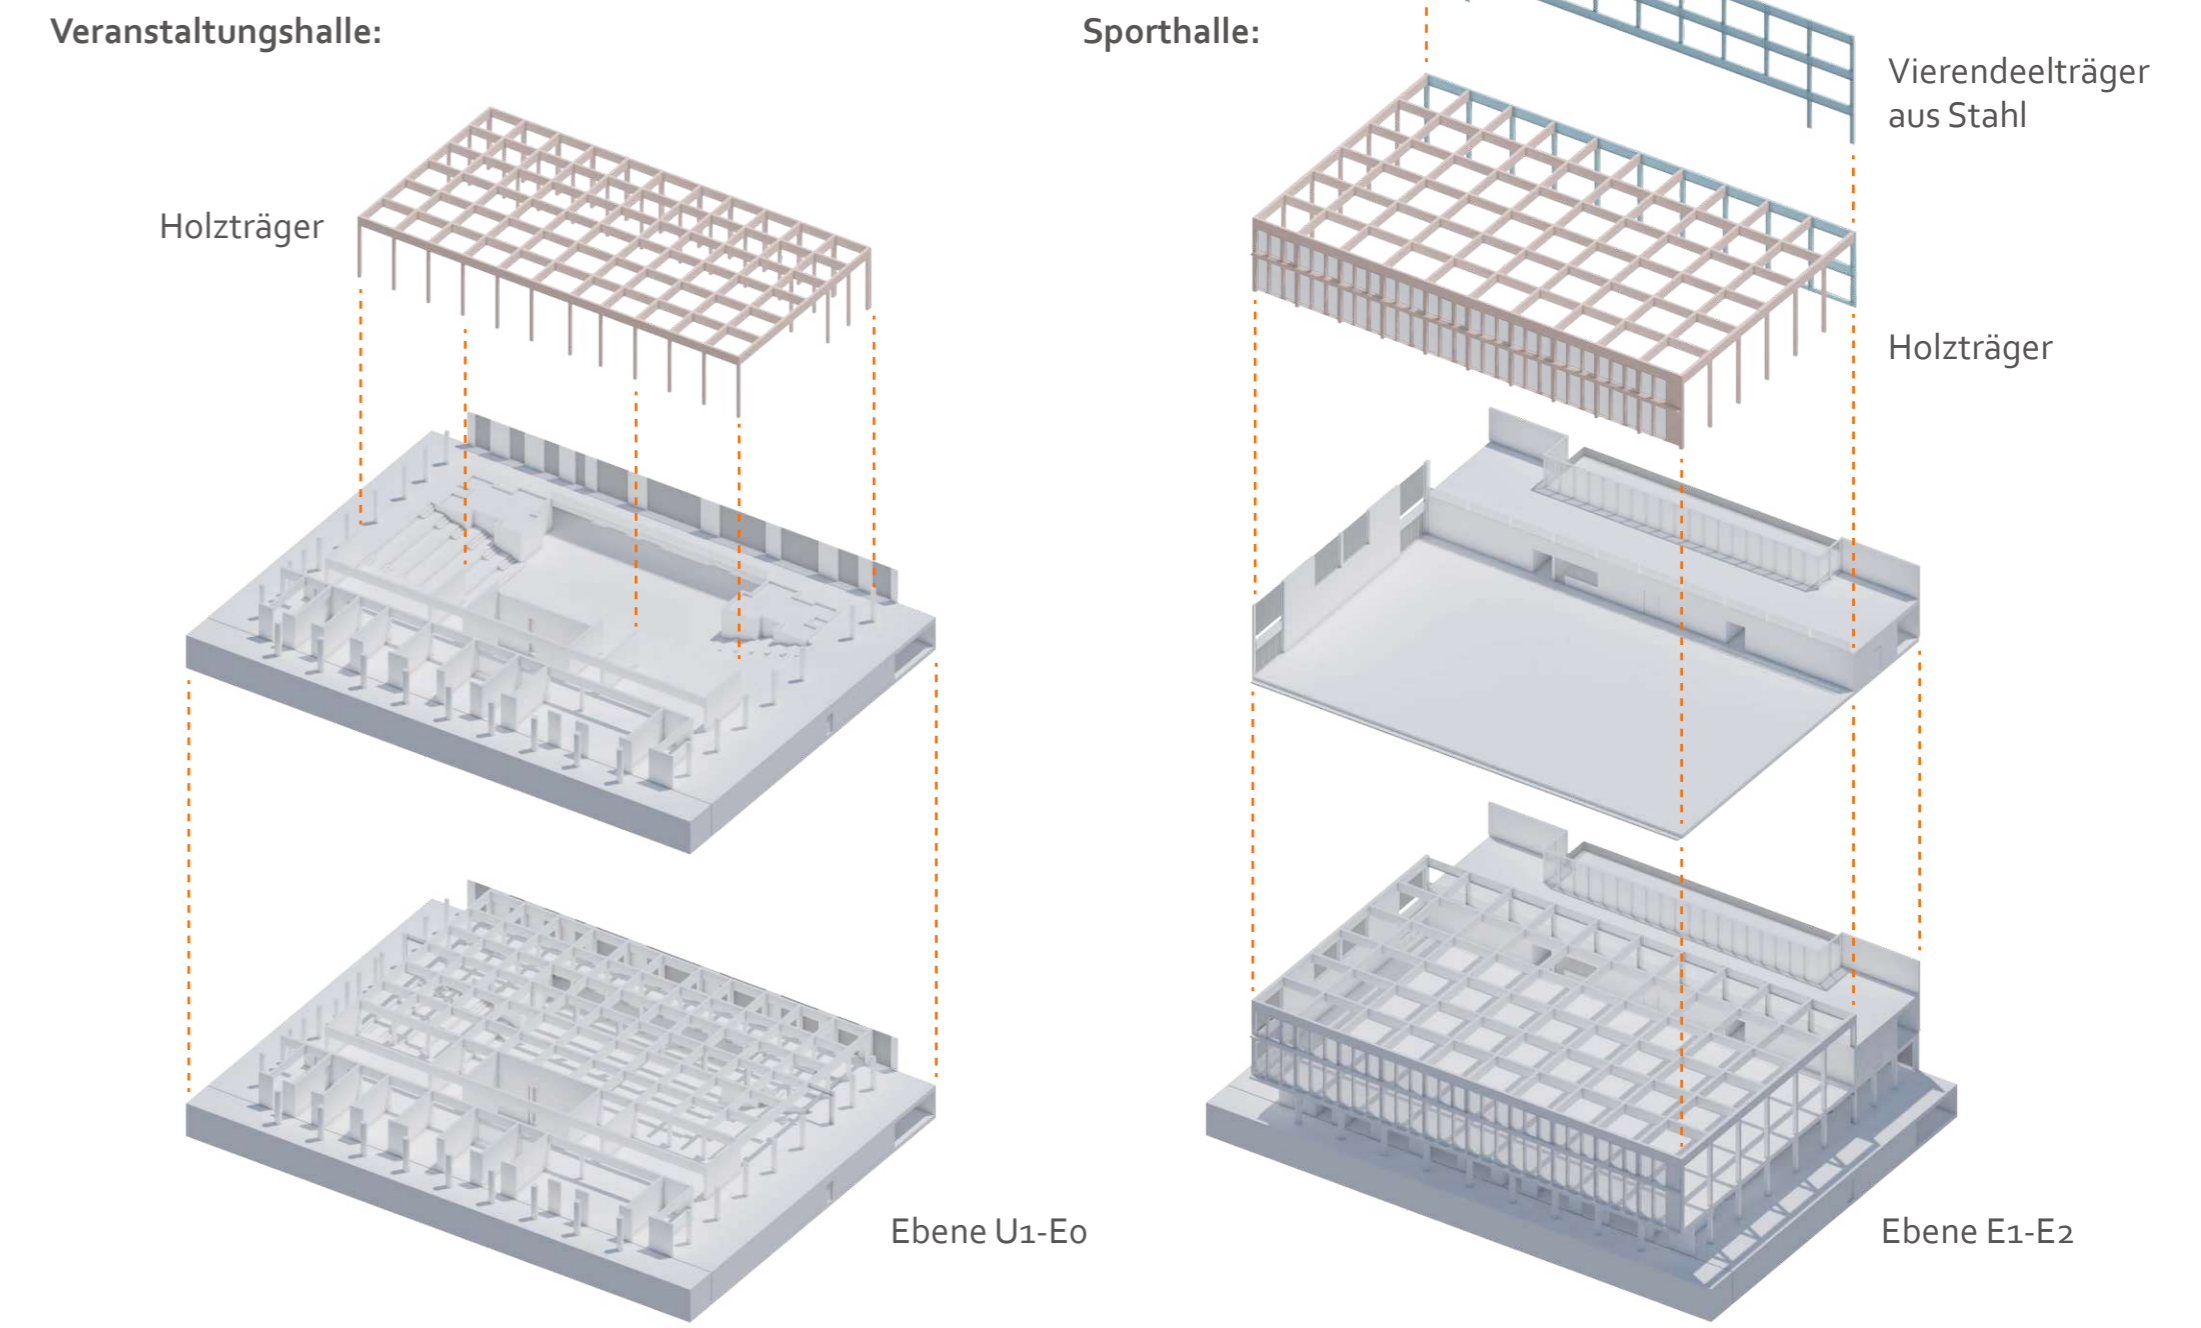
Tragwerk/Konstruktion/Hybridbauweise: Veranstaltungs- und Sporthalle
